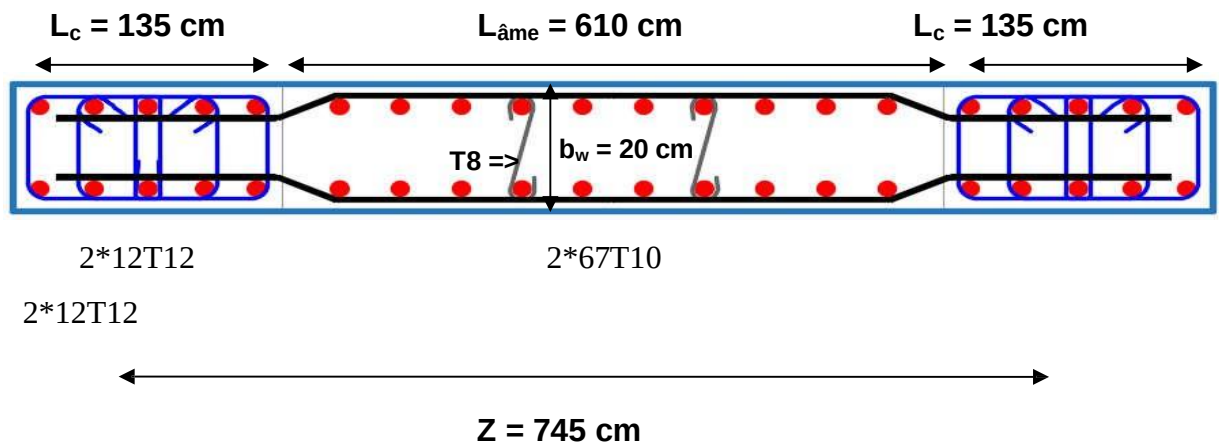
Schéma de ferrailage sur la hauteur critique (RPA2024)
